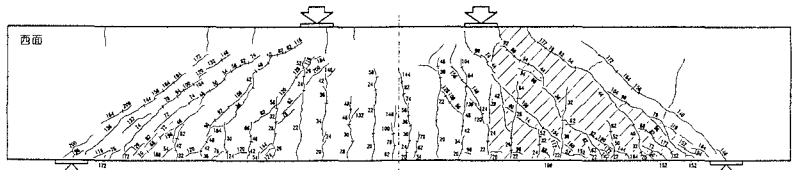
(2) 梁②試験体のひび割れ性状図
